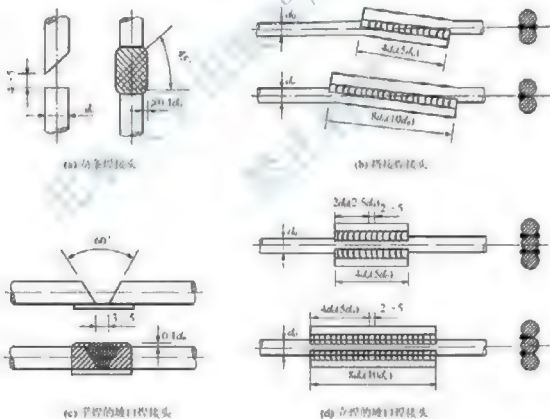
钢筋电弧焊的接头形式(单位: mm)
